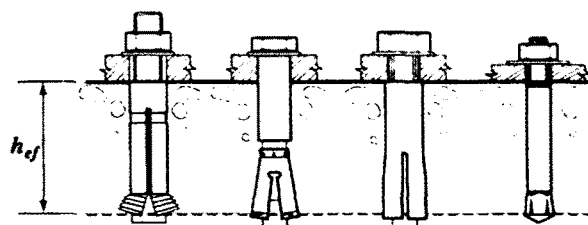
후설치 확장앵커(post-installed expansion anchor)
